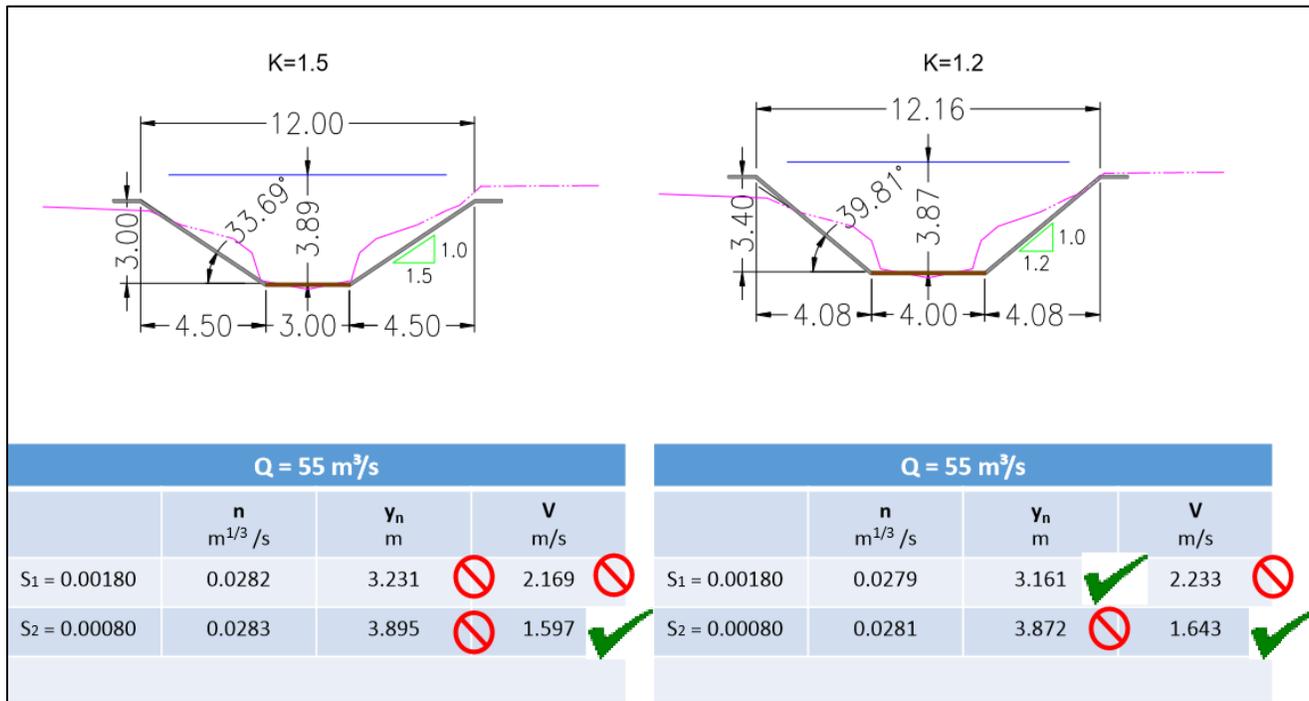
Opción 2 Sección de gaviones con fondo móvil (terreno natural).
